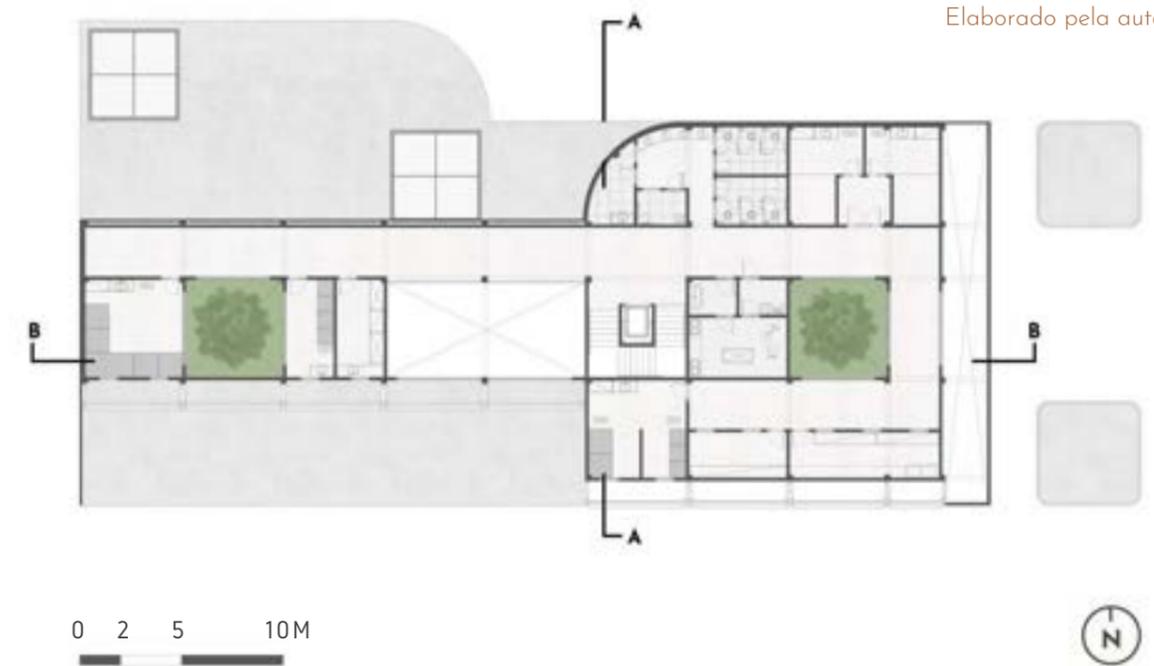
Planta baixa: Bloco Administrativo-Veterinário 1º Pavimento. Elaborado pela autora.
